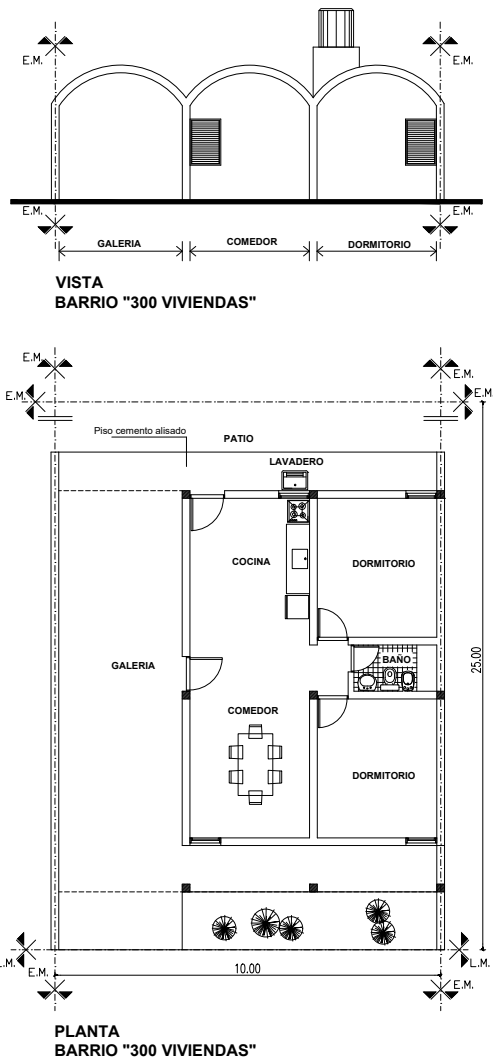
| Planta y vista de la tipología de dos dormitorios.
